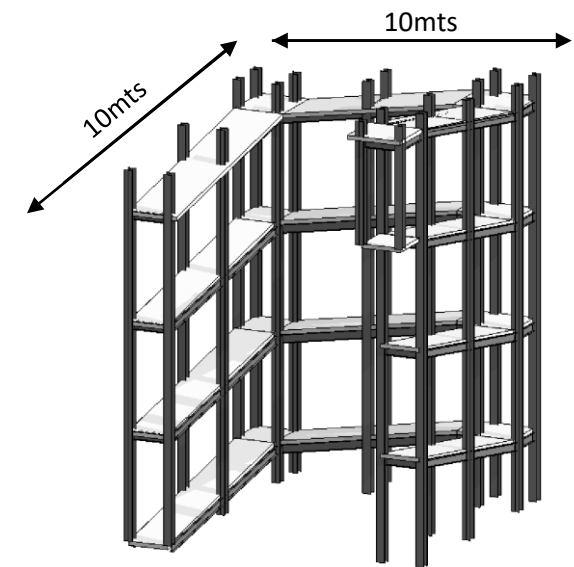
Detalle Estructural de Rampa. Fuente: Elaboración propia.
